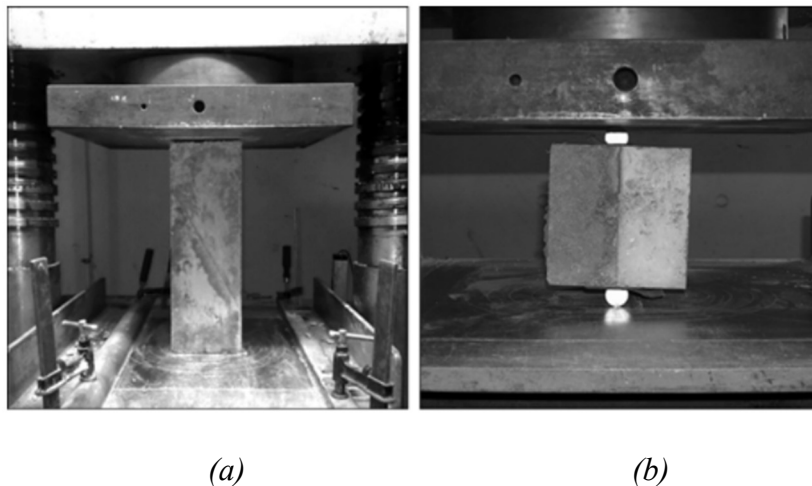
slant shear test (a) e splitting test (b)
